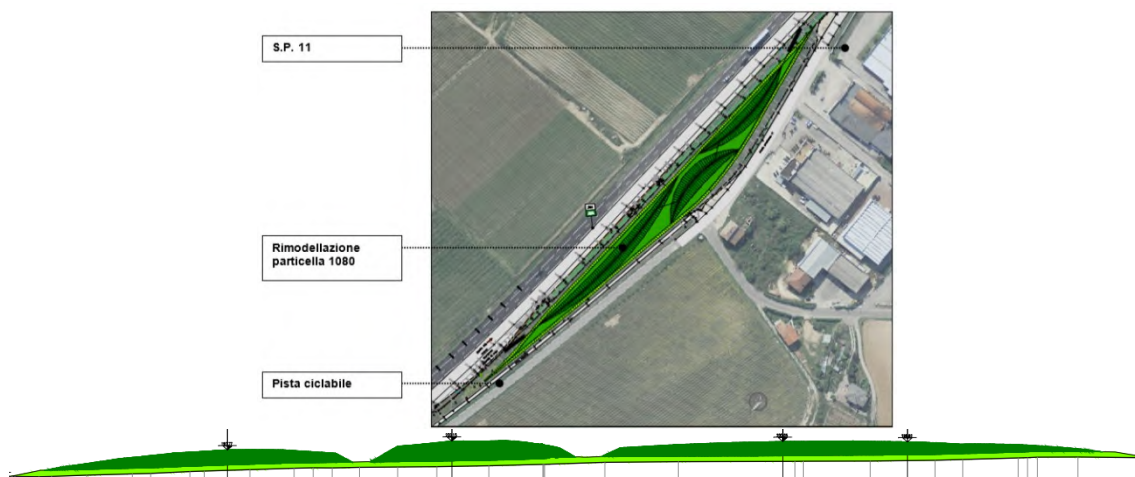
Planimetria di progetto (vedasi anche tavole progettuali di riferimento)
